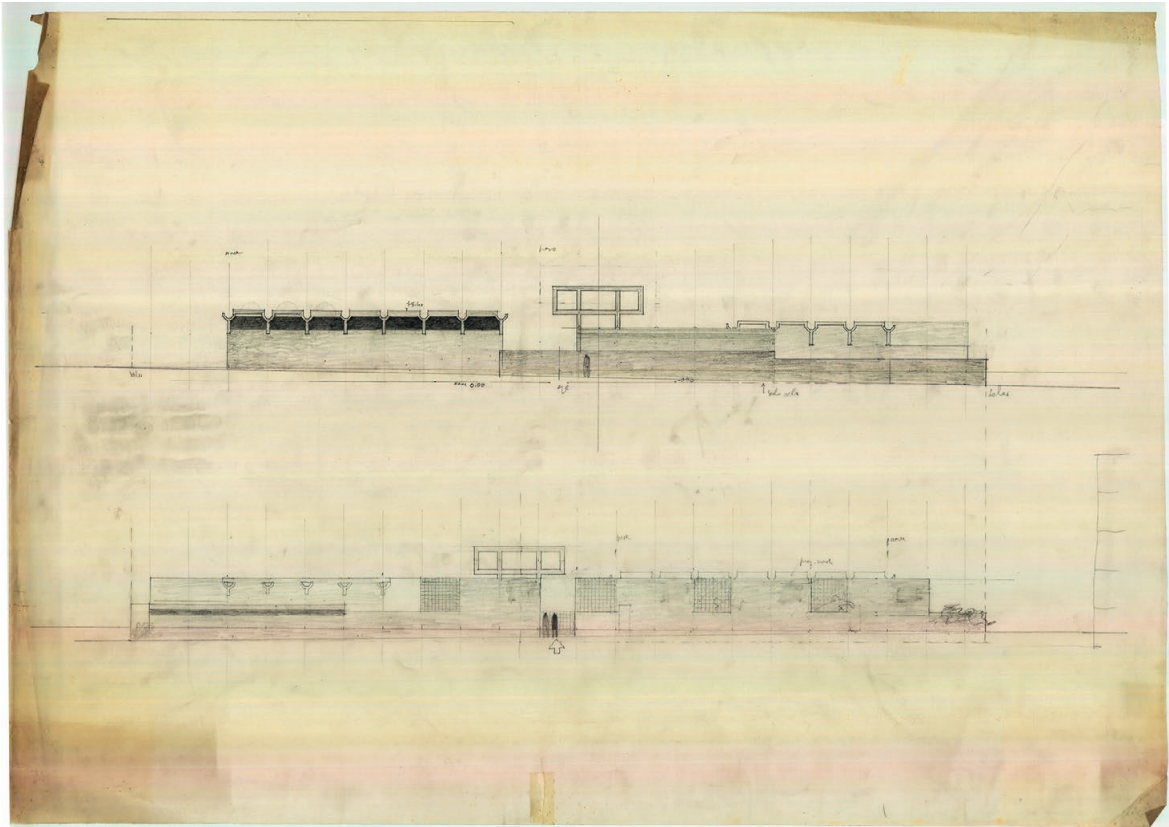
Sáenz de Oíza y Sierra. Anteproyecto de centro parroquial en el poblado dirigido de Entrevías, 1958. Alzados.
